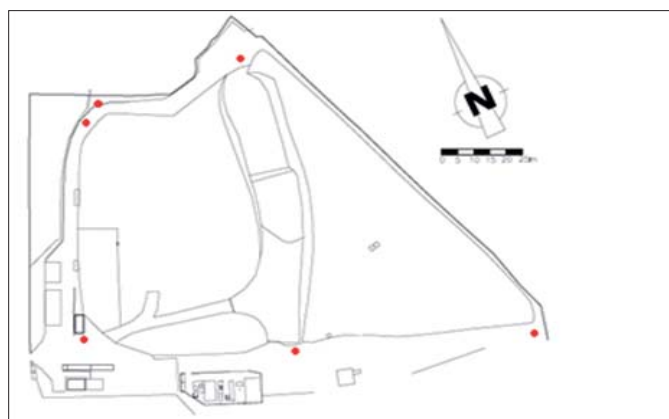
Planimetria dell'impianto di Grosso (TO).
